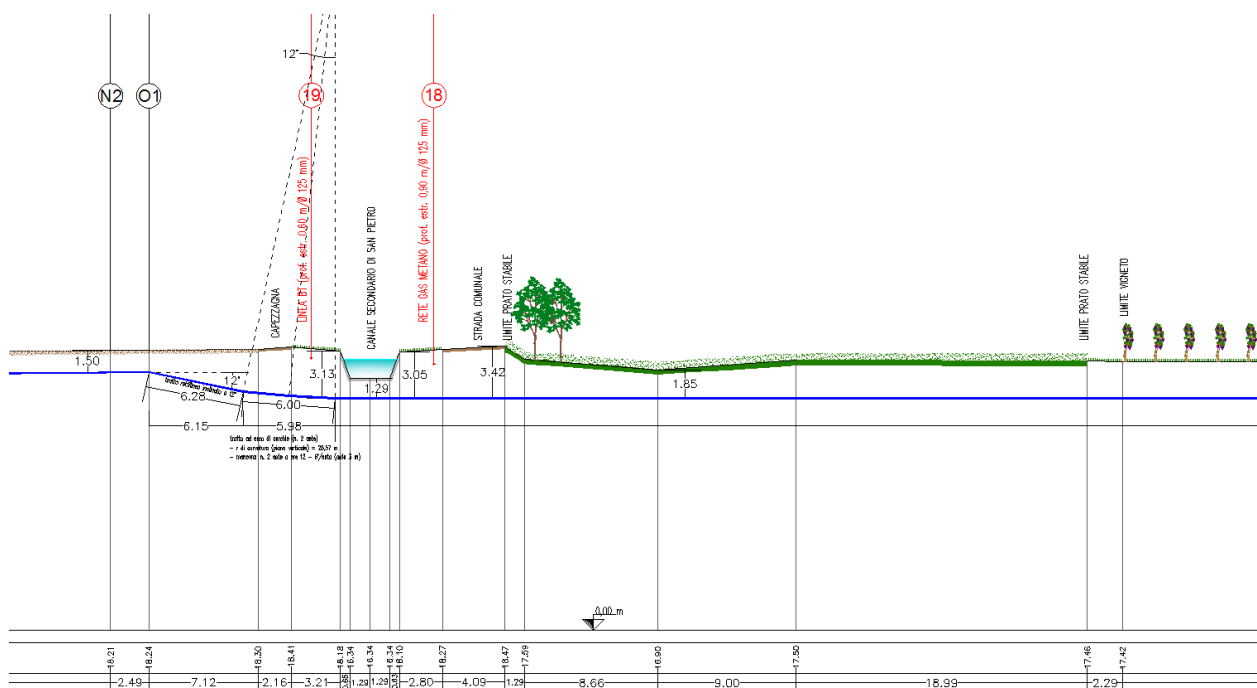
Profilo del cavo interrato sotto al prato stabile al punto 2.
